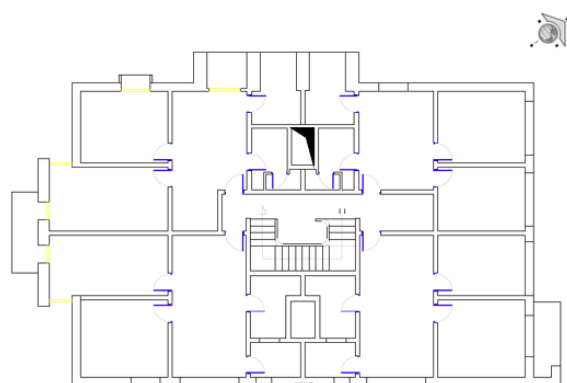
Plan dernier étage (source : OUKRIF Y, 2016)
